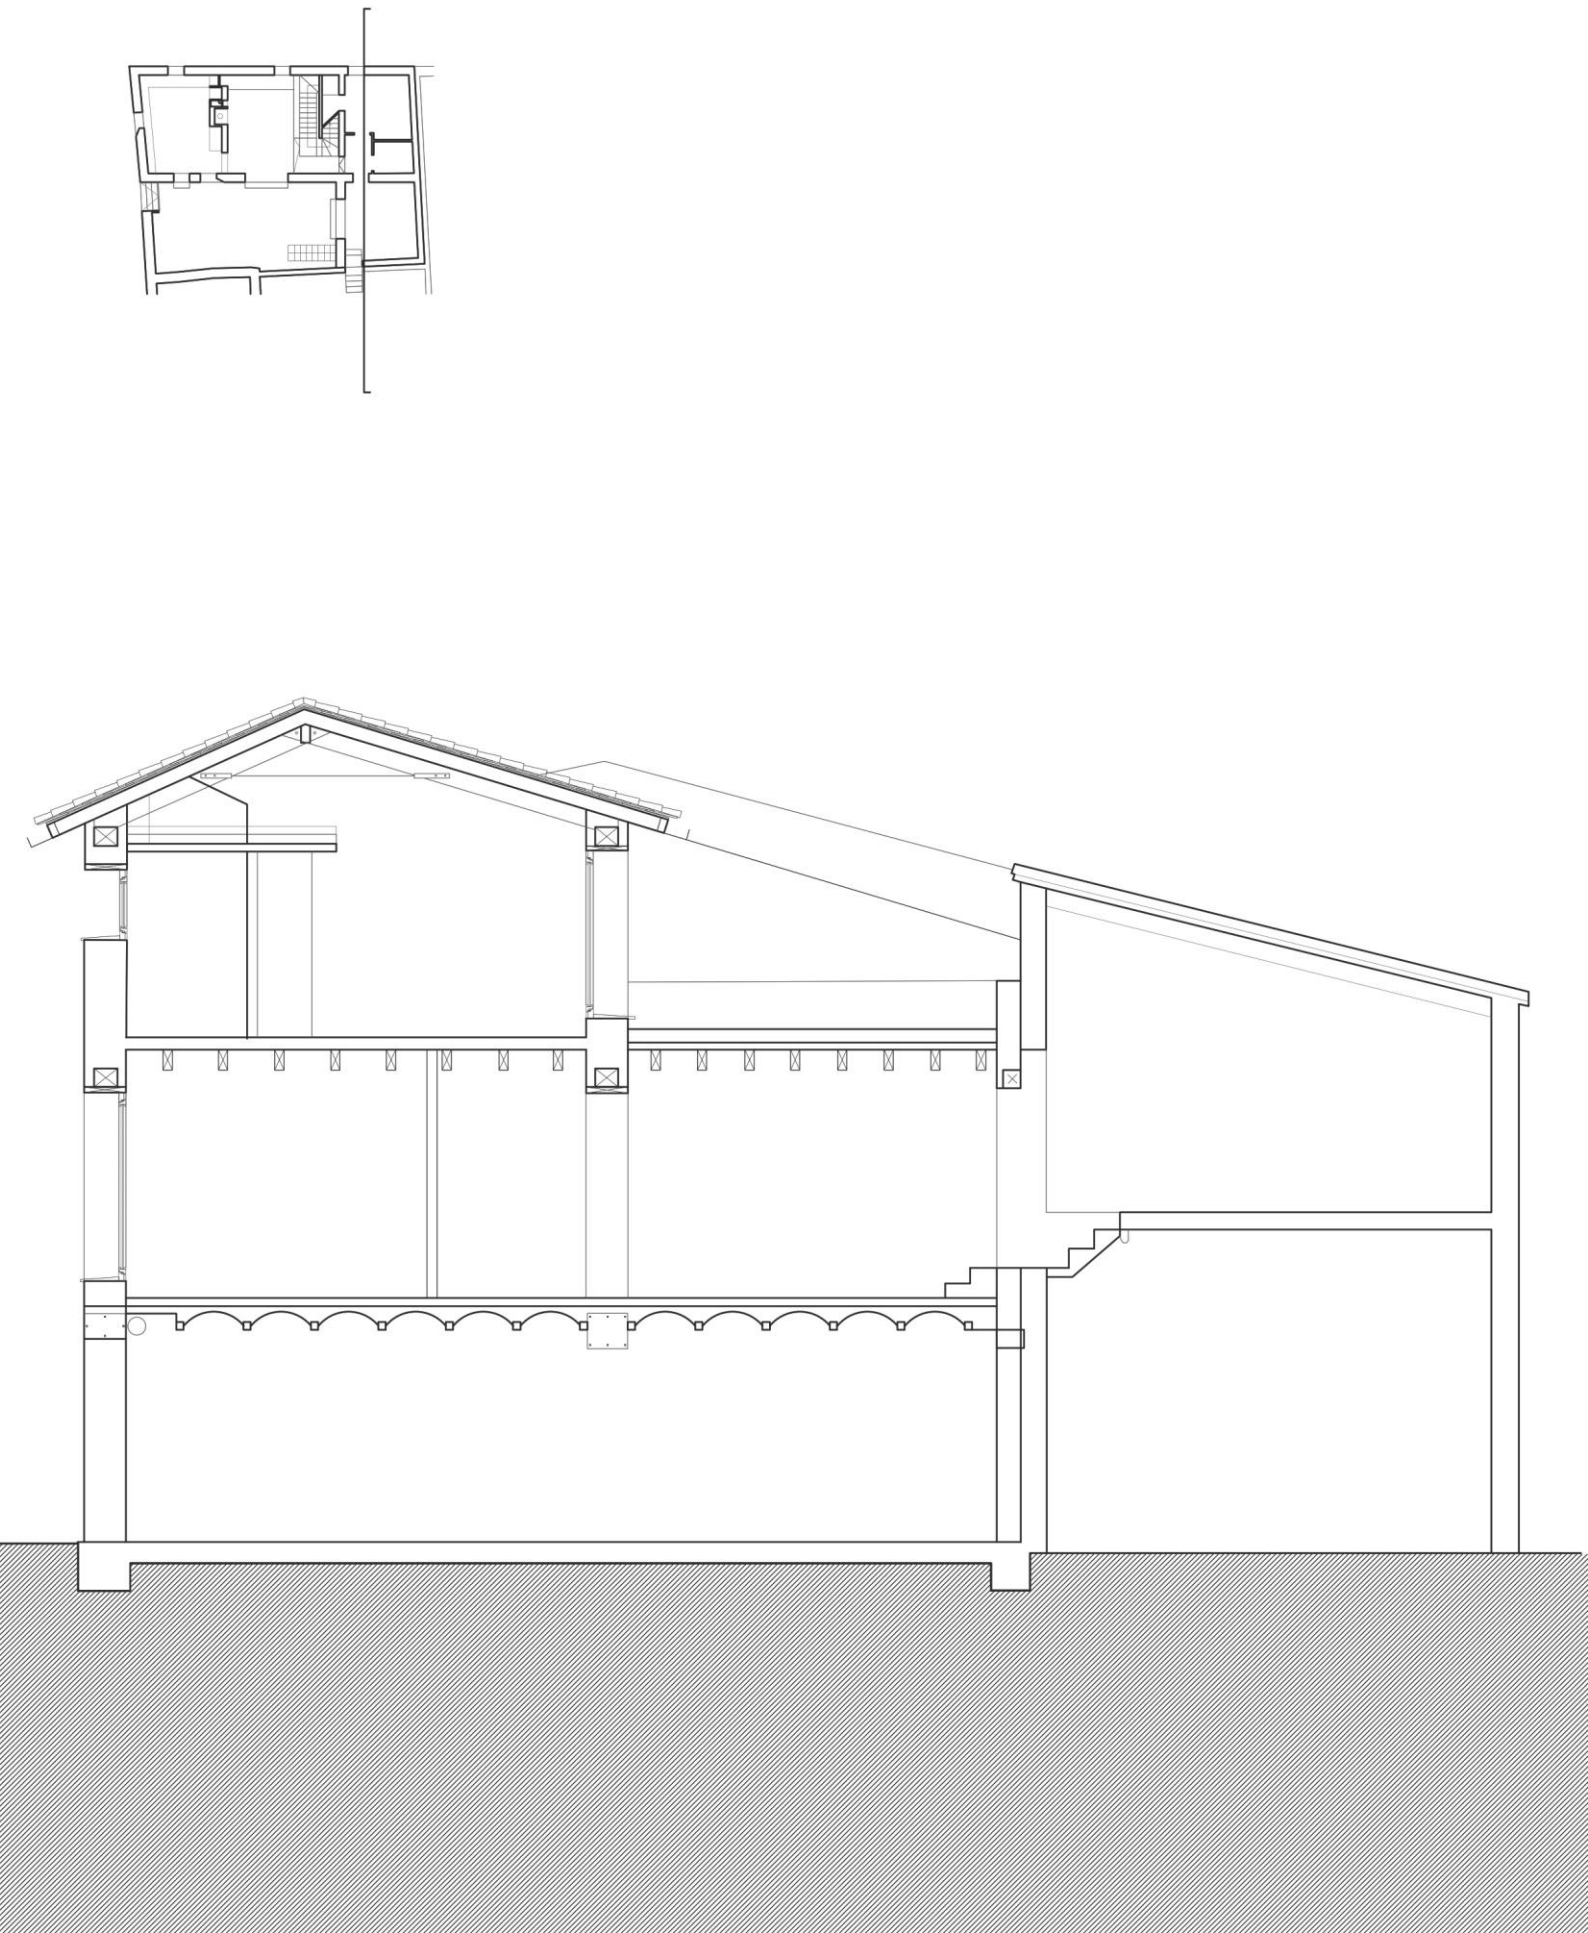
SECCIÓN C ARQUITECTURA TRASVERSAL
